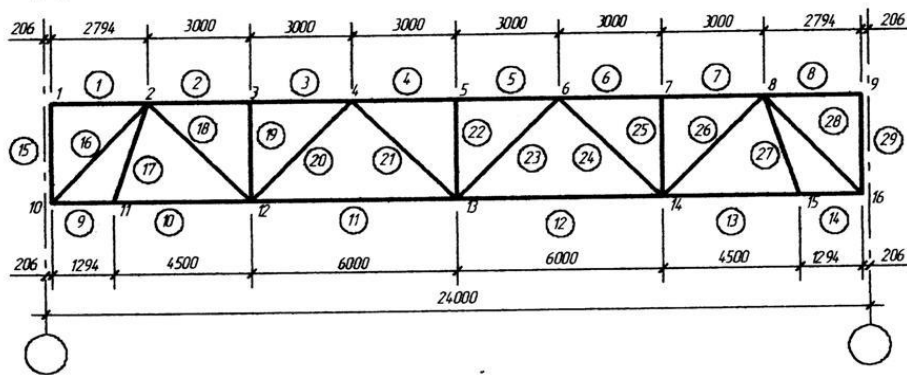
Розрахункова схема ферми для розрахунку на ПЕОМ:
